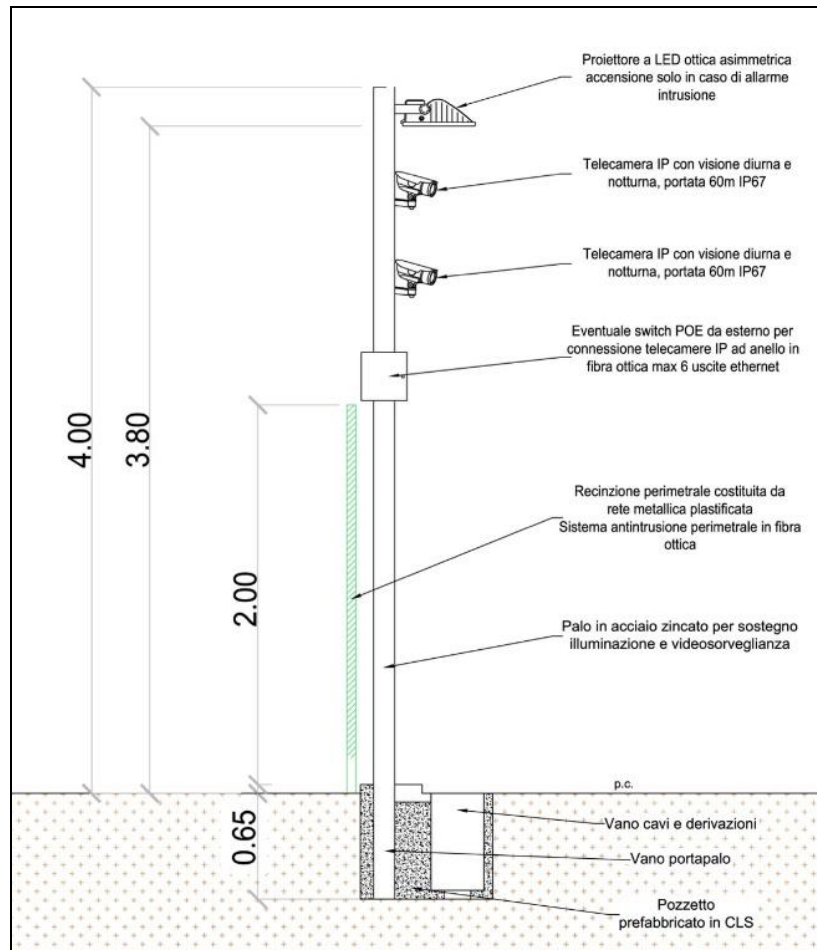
Particolare dei pali previsti per illuminazione e videosorveglianza con fondazione prefabbricata a pozzetto.
